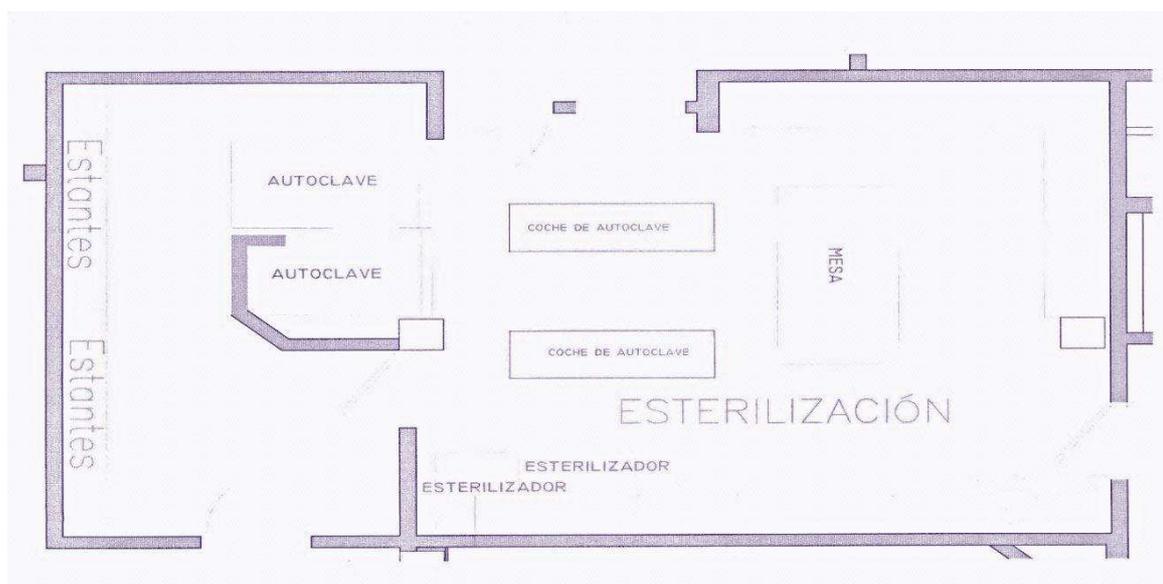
Plano de la sala de esterilización con la distribución de las áreas
